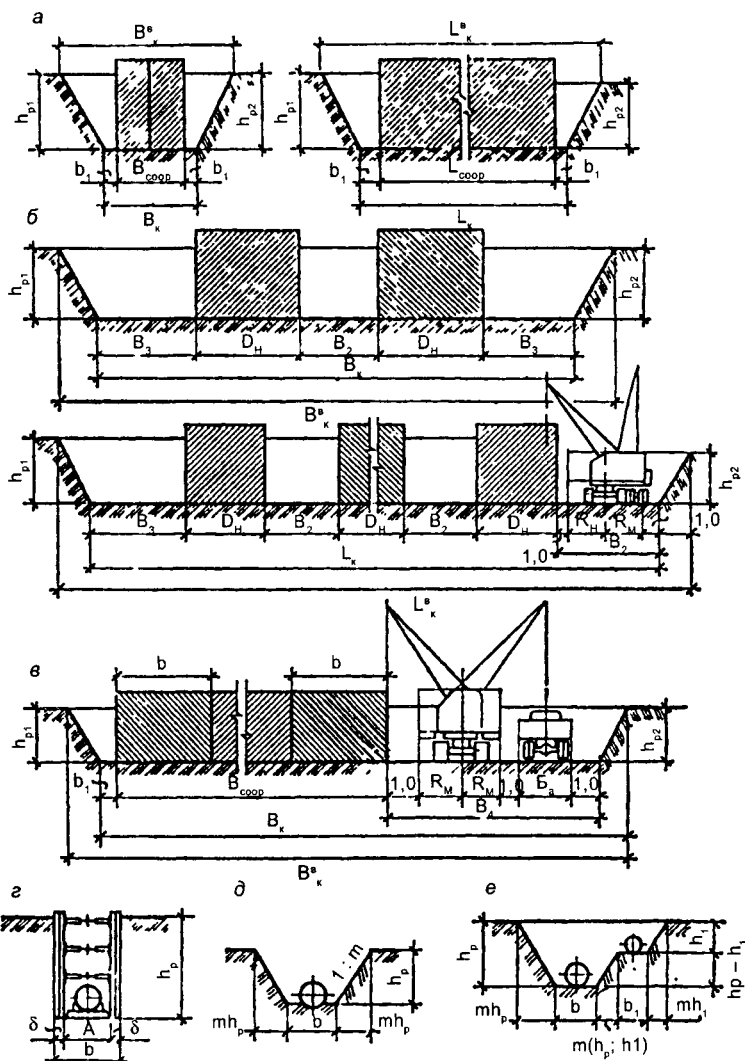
Схема для определения размеров котлованов и траншей:
